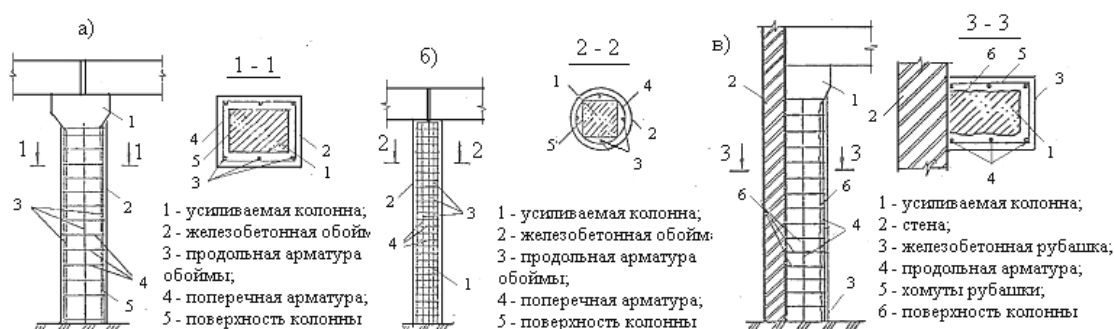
Усиление железобетонных колонн устройством железобетонной обоймы (а), железобетонной обоймы с косвенным армированием (б) и железобетонной рубашкой (в)
